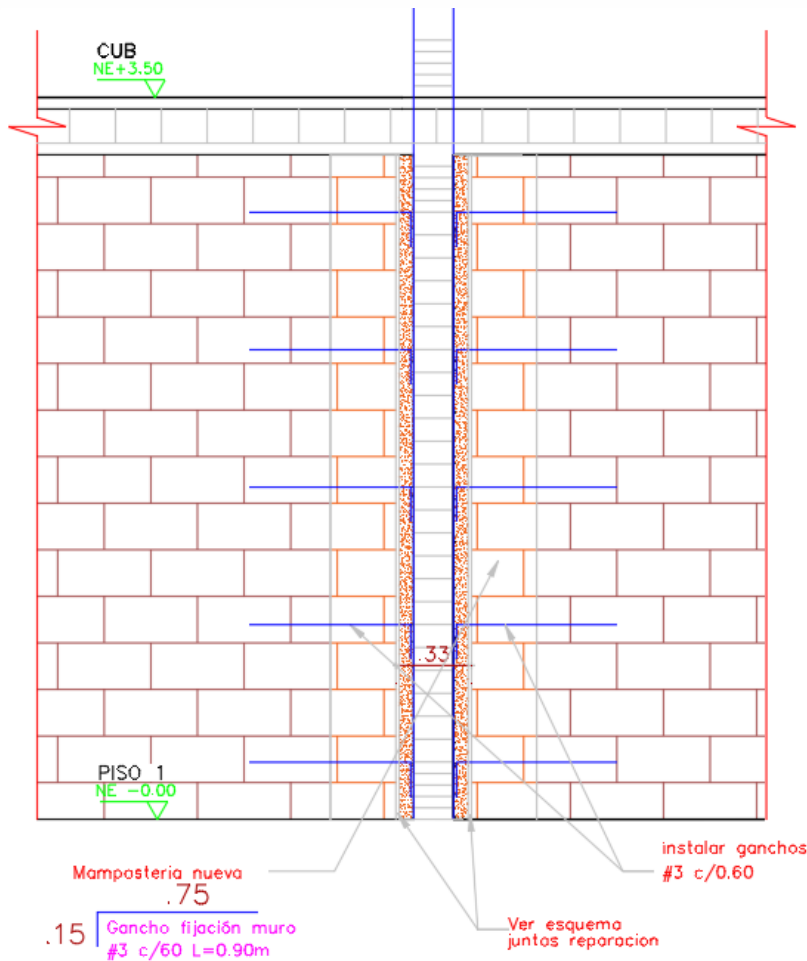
Esquema Final del Reforzamiento en Pórtico de Concreto.
